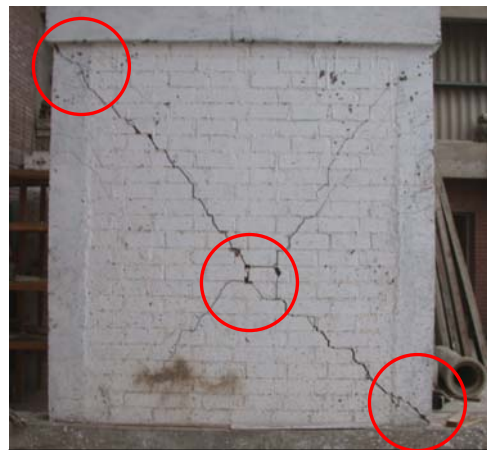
Muro Original al finalizar el ensayo y antes de la reparación.
